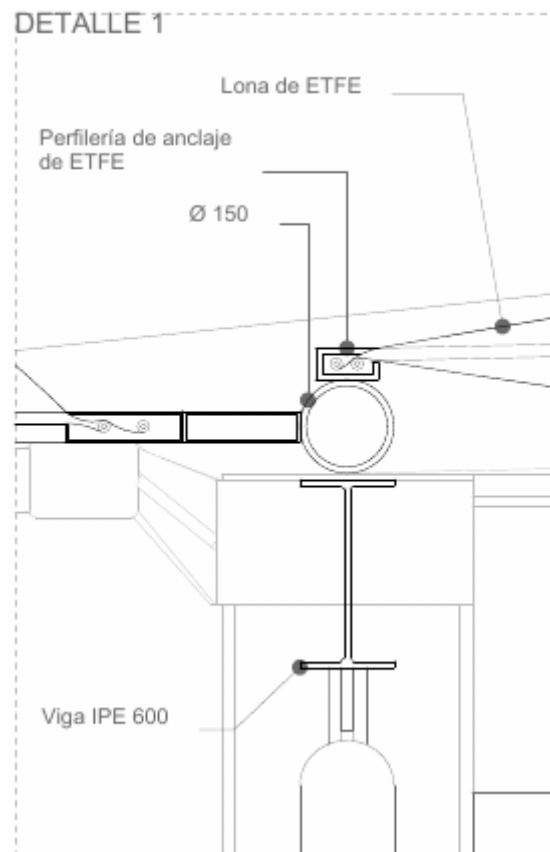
Detalle 1 de unión entre vigas, subestructura, perfilaría y lona de ETFE, Fuente: Elaboración propia
